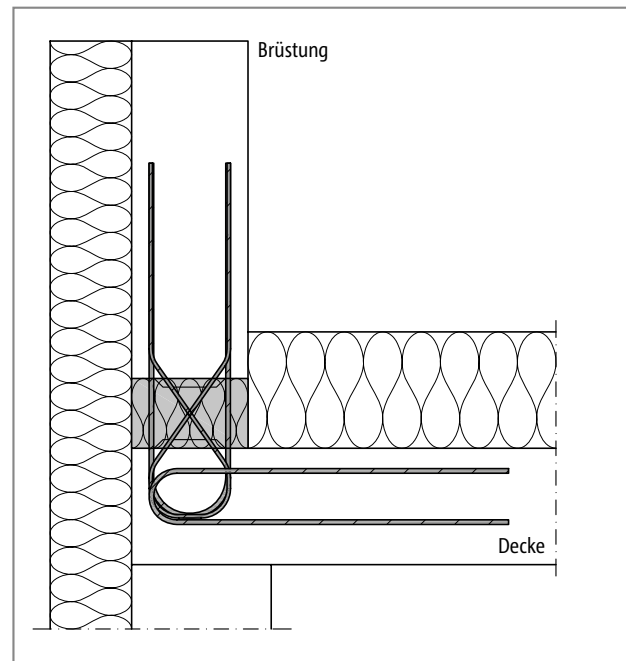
Schöck Isokorb® XT Typ A: Anschluss einer Brüstung (XT Typ A-MM2)
